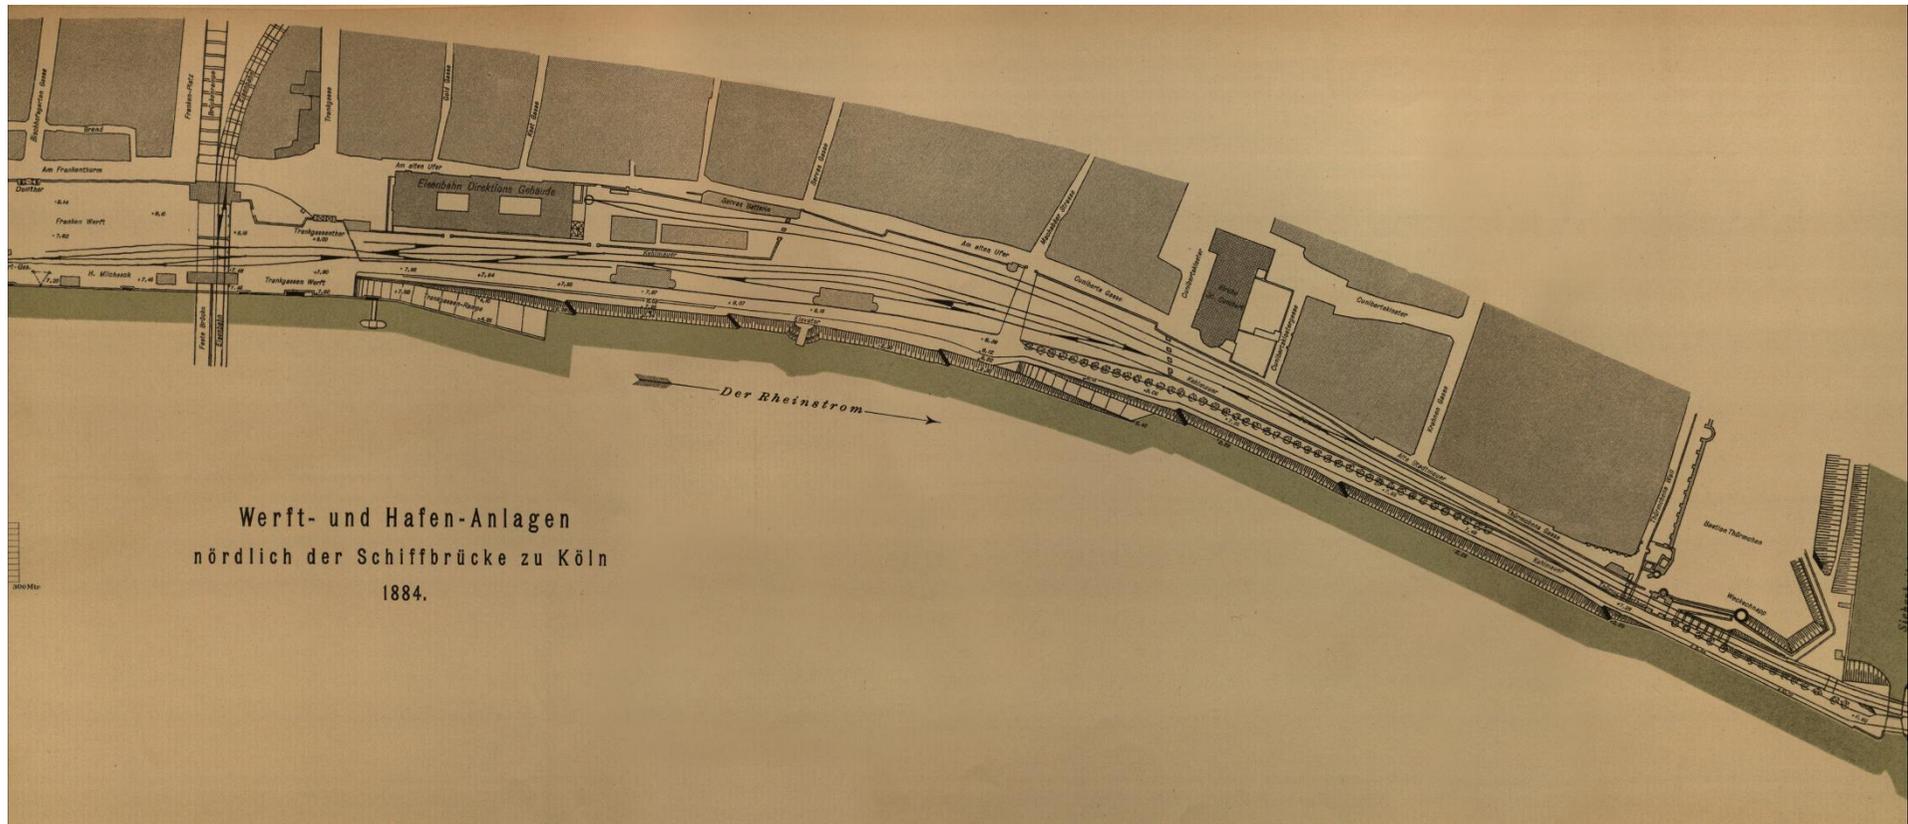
Lageplan der Werft- und Hafenanlagen nördlich der Schiffbrücke zu Köln im Jahre 1884 (Ausschnitt). Links die Dombrücke, rechts die Thürmchensbas-
